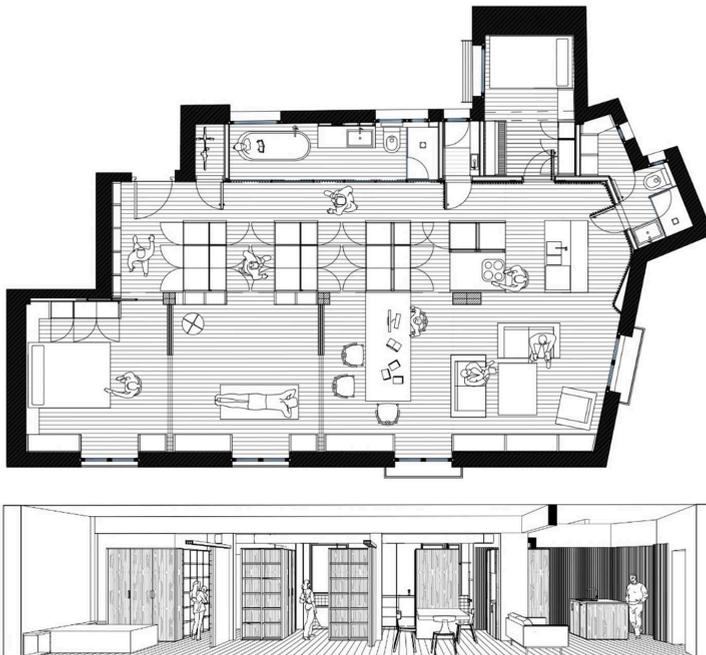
Planta y sección de proyecto de vivienda para una persona sola.
